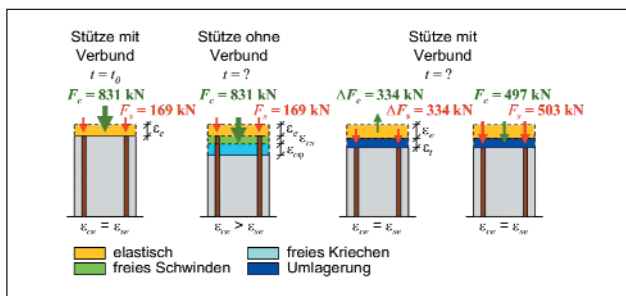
Umlagerung der Schnittkraftverteilung in einer Stahlbetonstütze
